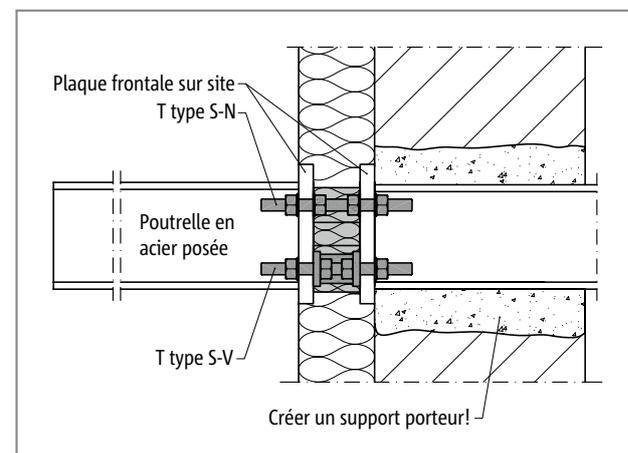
Schöck Isokorb® T type S-N et T type S-V : construction en acier supportée ultérieurement; pour d'autres exemples de rénovation, voir p. 96
